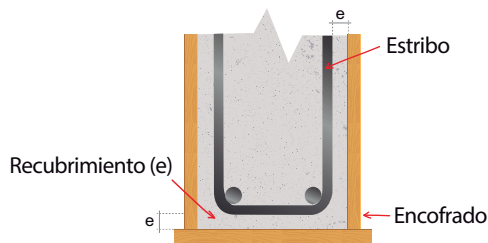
Detalles de separadores de acero y recubrimiento de concreto
